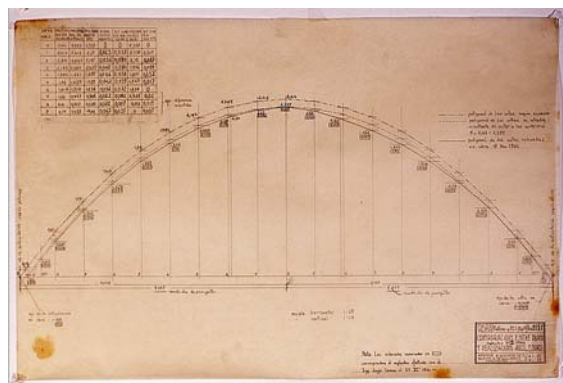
Plano nº 1131, indicando las desviaciones del encofrado detectadas en obra (Archivo Williams).
